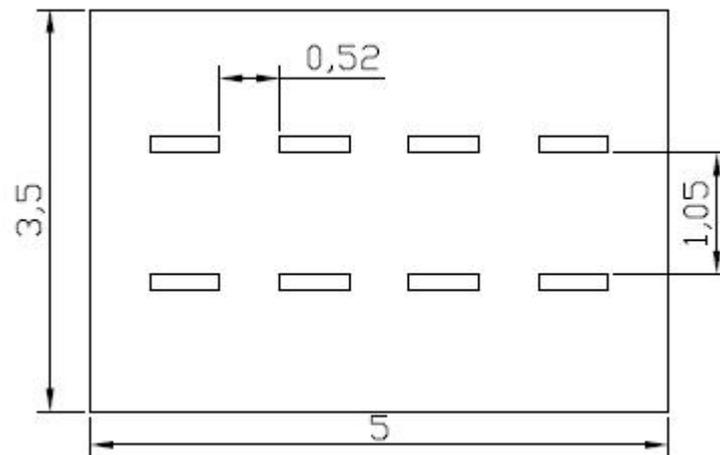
Distribución en planta de las luminarias de la sala TV.
